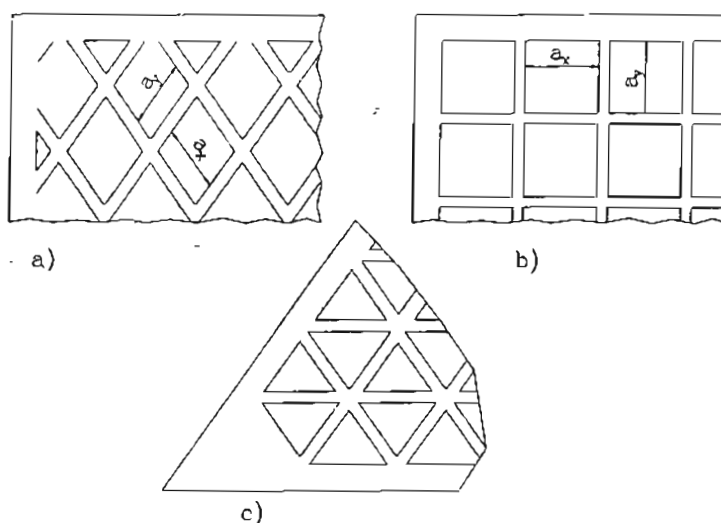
Lajes nervuradas em duas ou três direções
